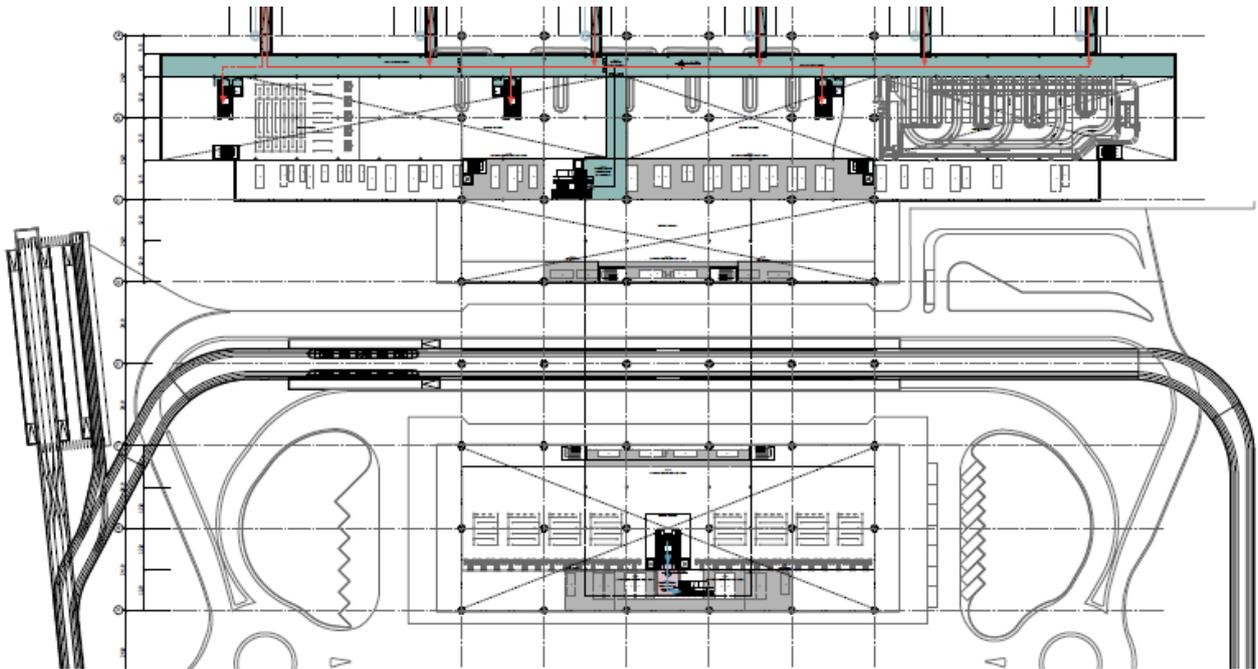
| Pianta del mezzanino 2035 circolazione ed aree tecniche
